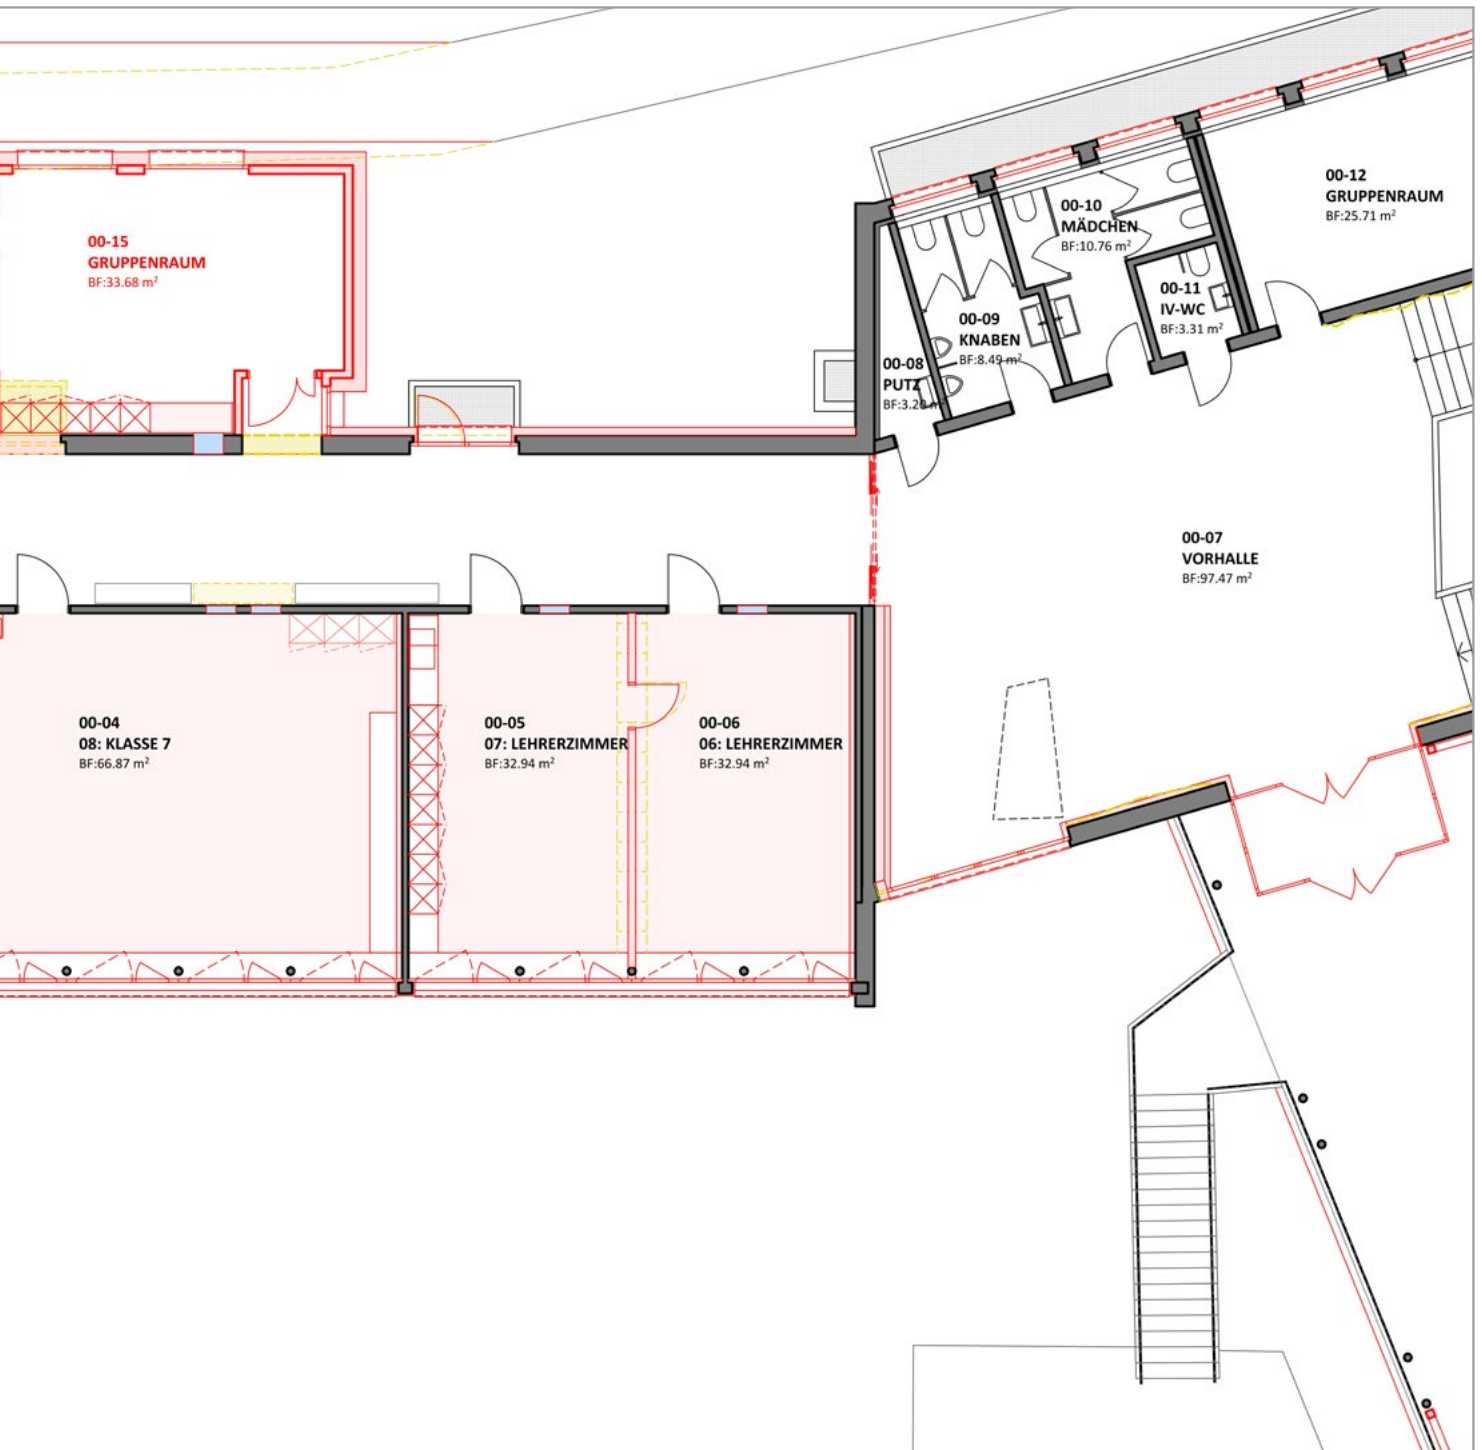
Grundriss EG Schulhaus Zentral
